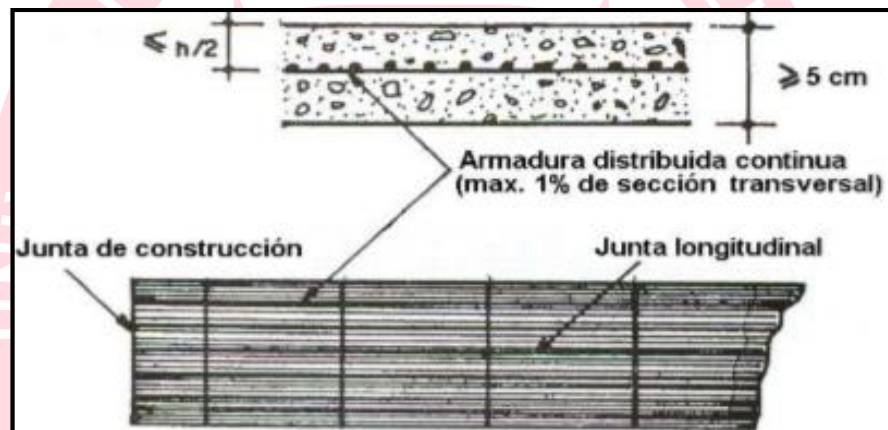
Pavimento de concreto con refuerzo de acero continuo.
